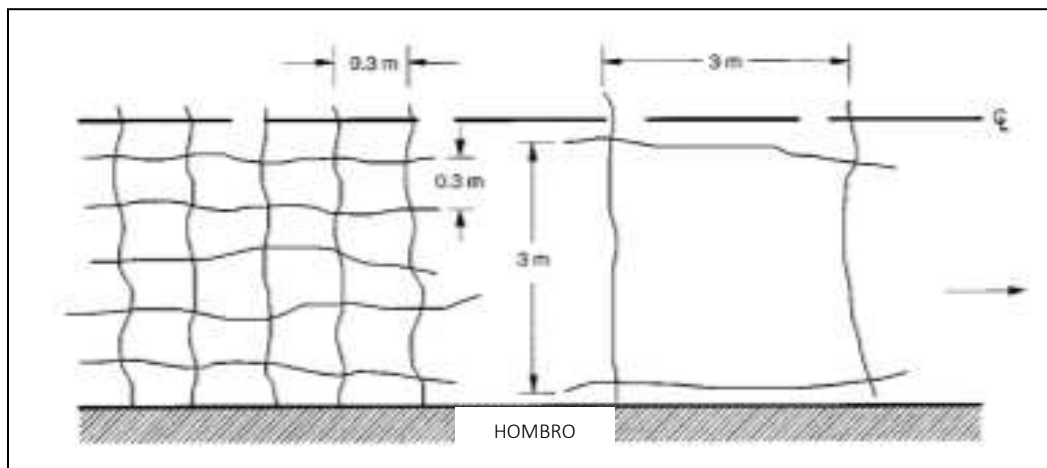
Fisuras y grietas en bloque. (FHWA, 2003)
